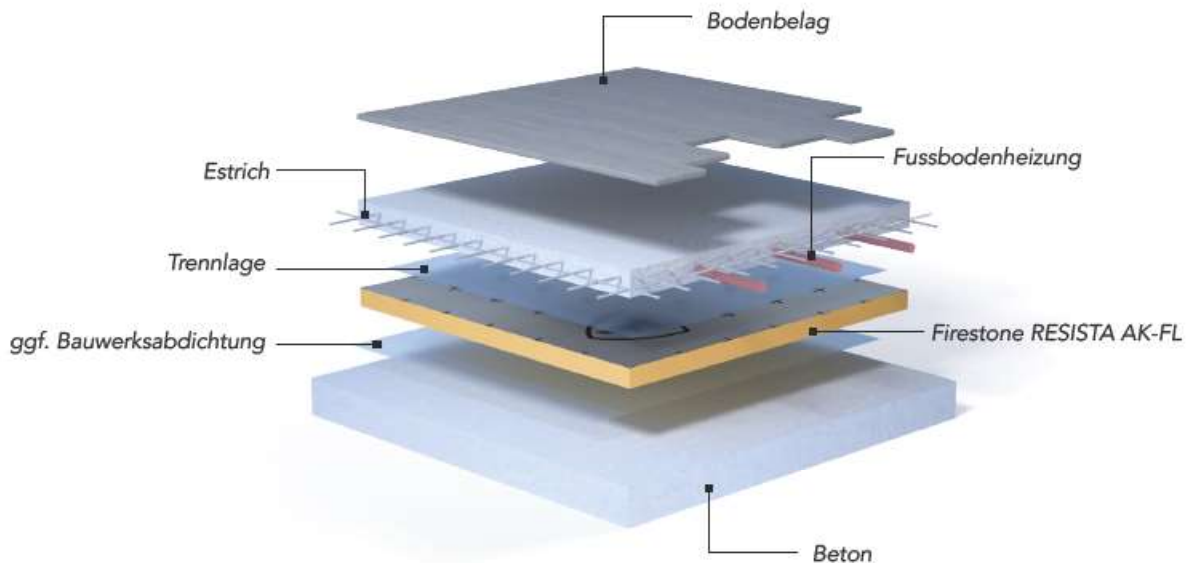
Dämmungsaufbau auf einer Betondecke
